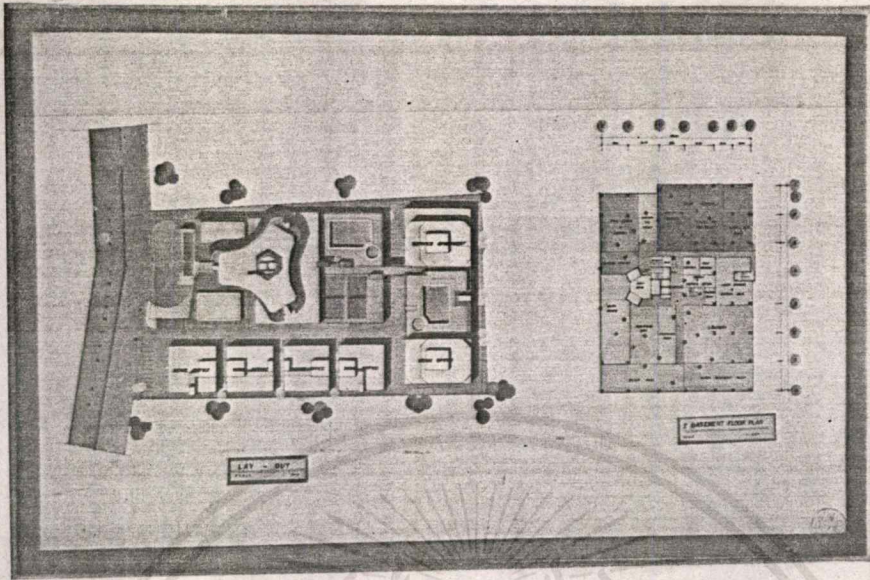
แสดงความเป็นไปได้ของโครงการ 2.
